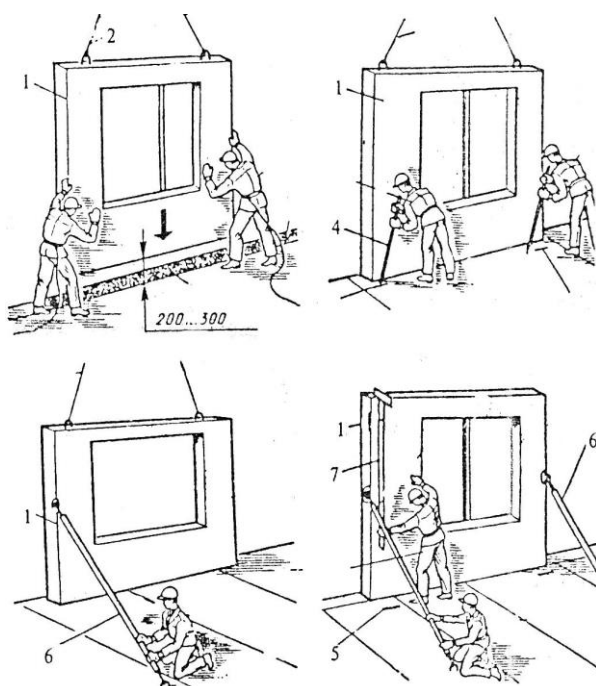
Схема последовательного монтажа наружной стеновой панели:
